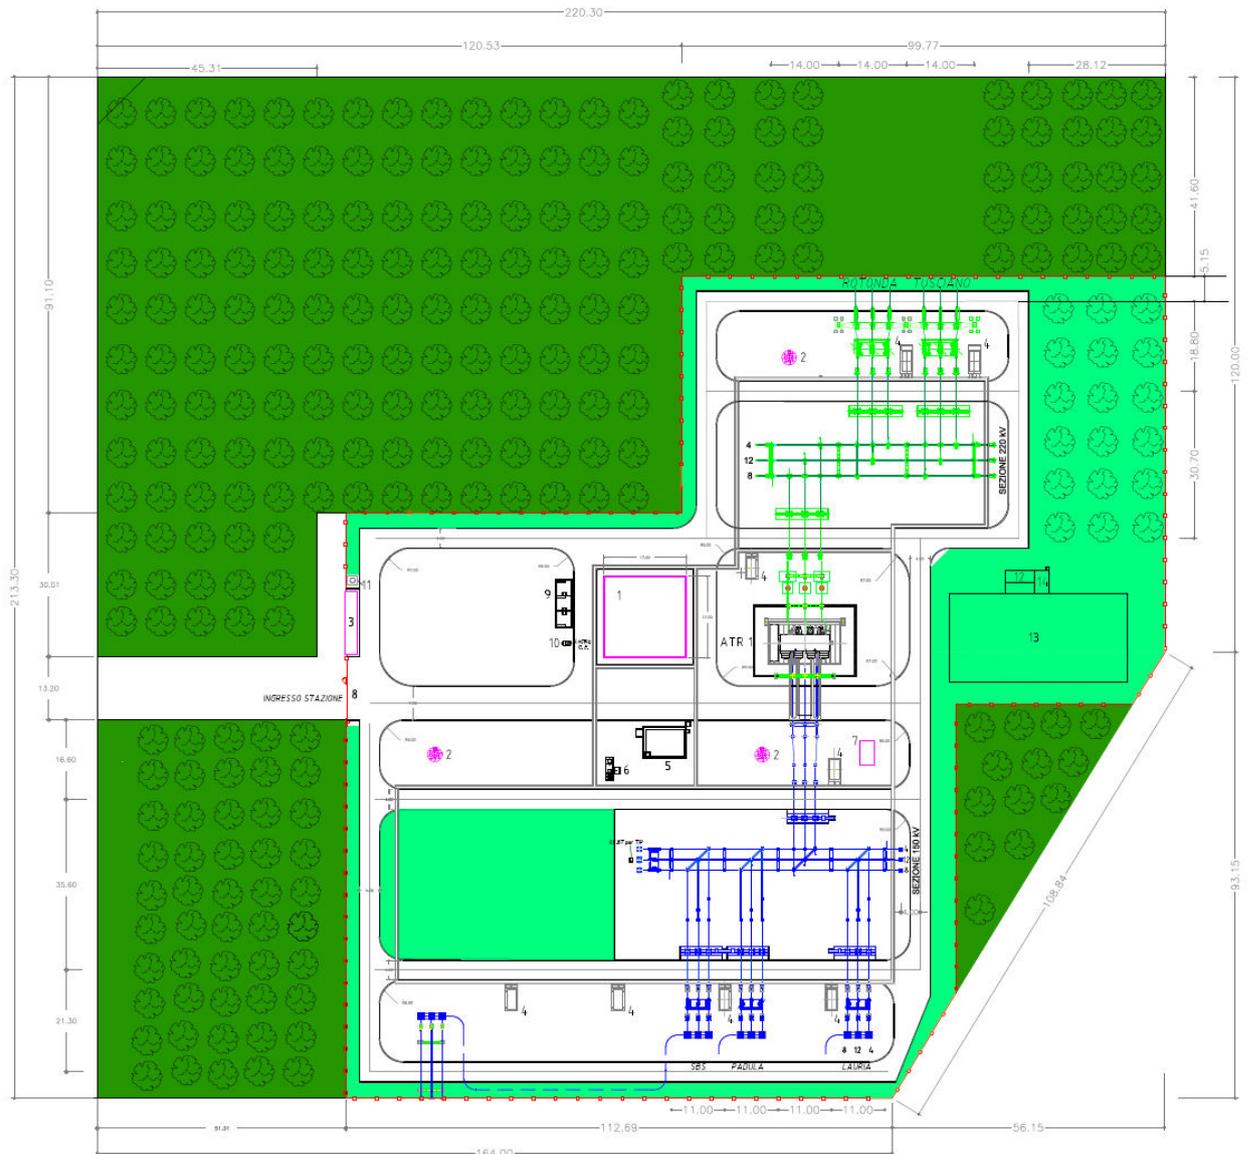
Planimetria elettromeccanica generale – Progetto originario
